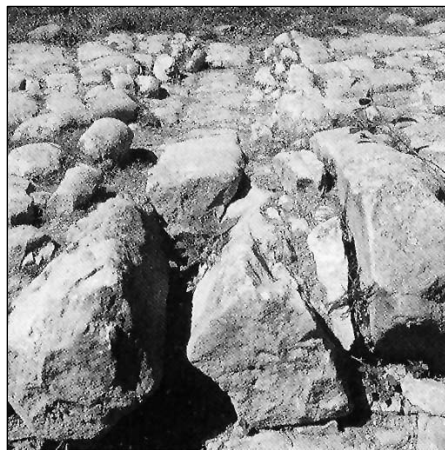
Bóveda de tres sillares para drenaje transversal.
